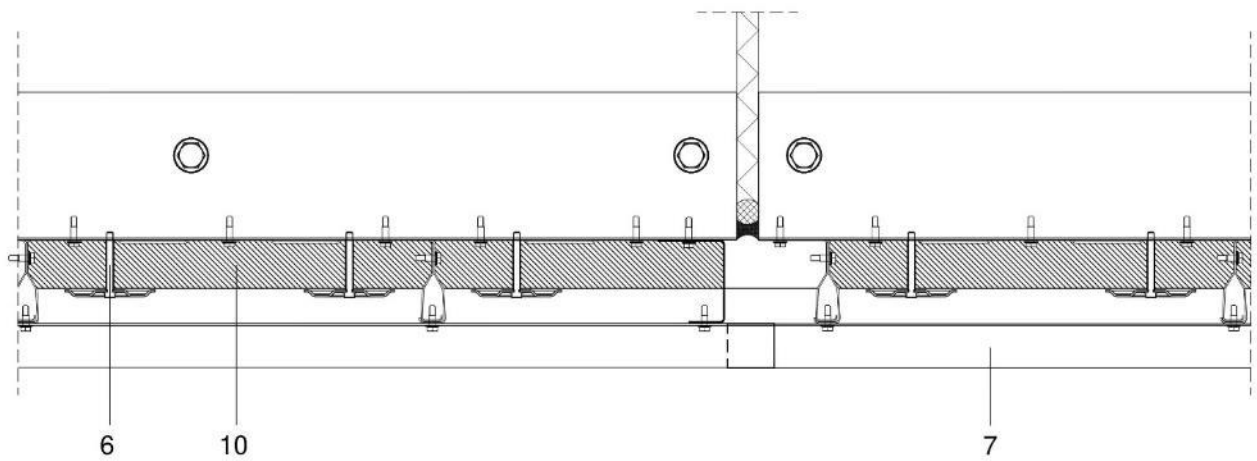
b: Detalle de junta de dilatación con aislamiento térmico.
